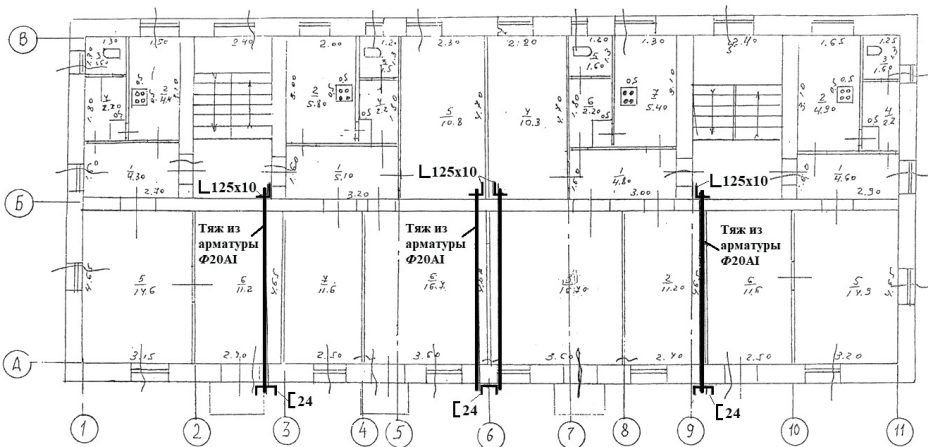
План 2-го этажа. Схема расположения трещин в стенах здания (составлена подрядчиком)
